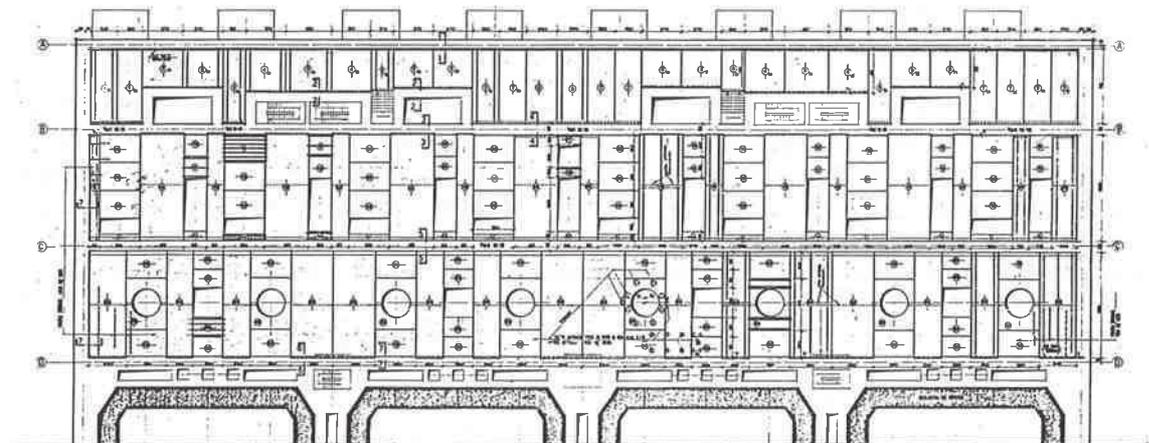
Pianta del solaio di copertura con la disposizione delle predalles.
